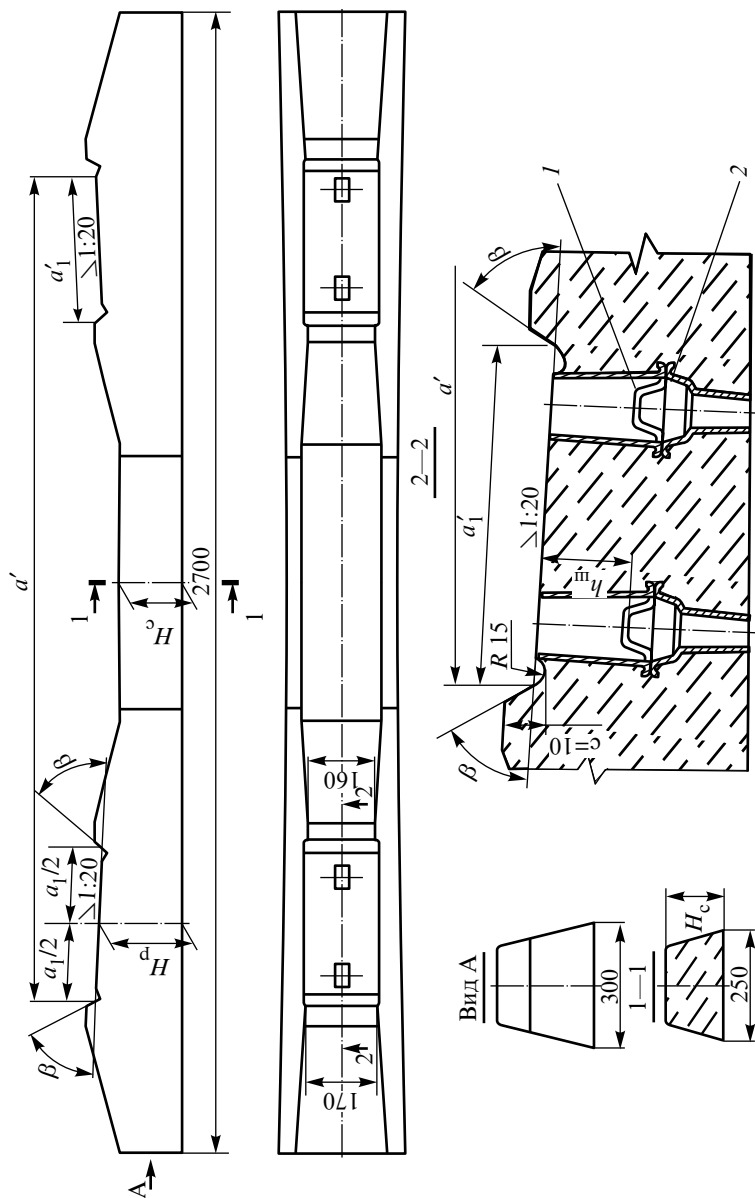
Общий вид железобетонной шпалы ШЗ:
